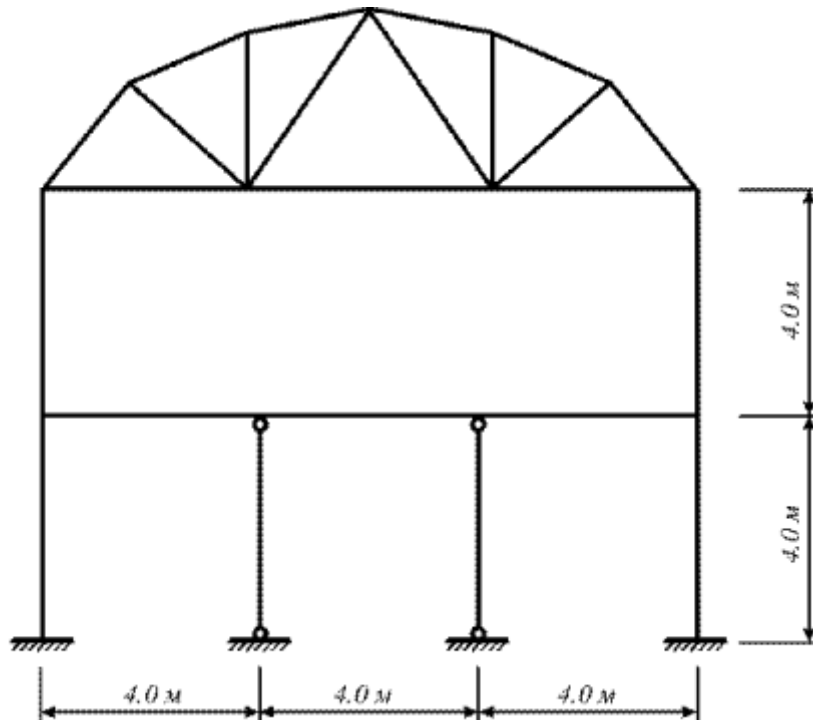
Розрахункова схема поперечного перетину будівлі
